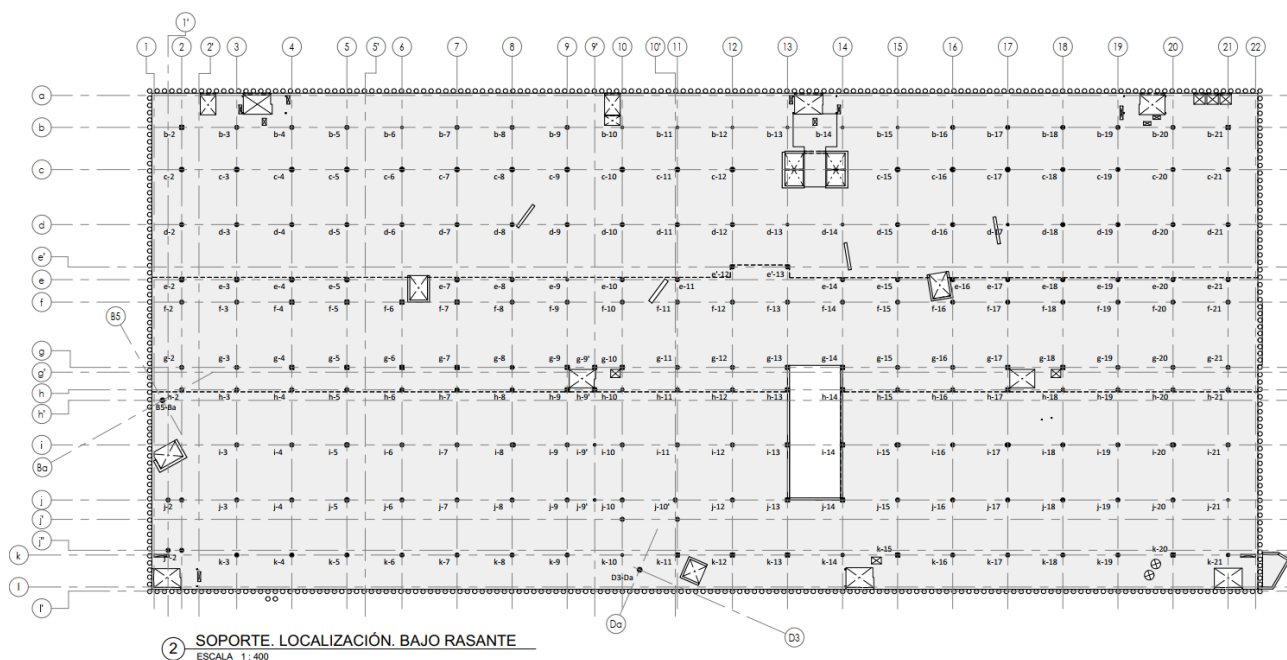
Planta bajo rasante, con franja media horizontal de mayor luz para la circulación de vehículos
